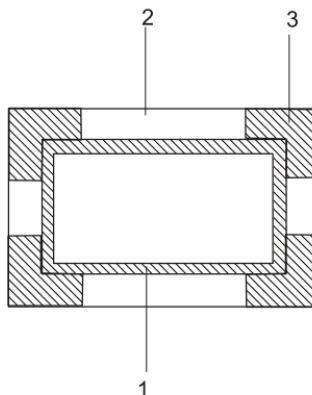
Утепление с учетом потерь тепла через наружные углы здания:
